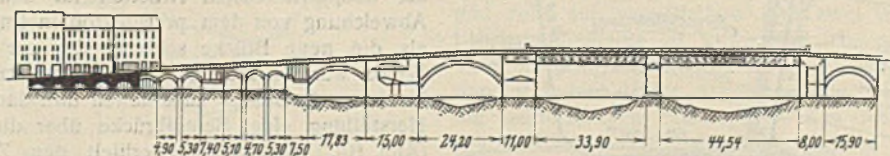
Zustand der alten Brücke vor dem Abbruch 1933/34.
